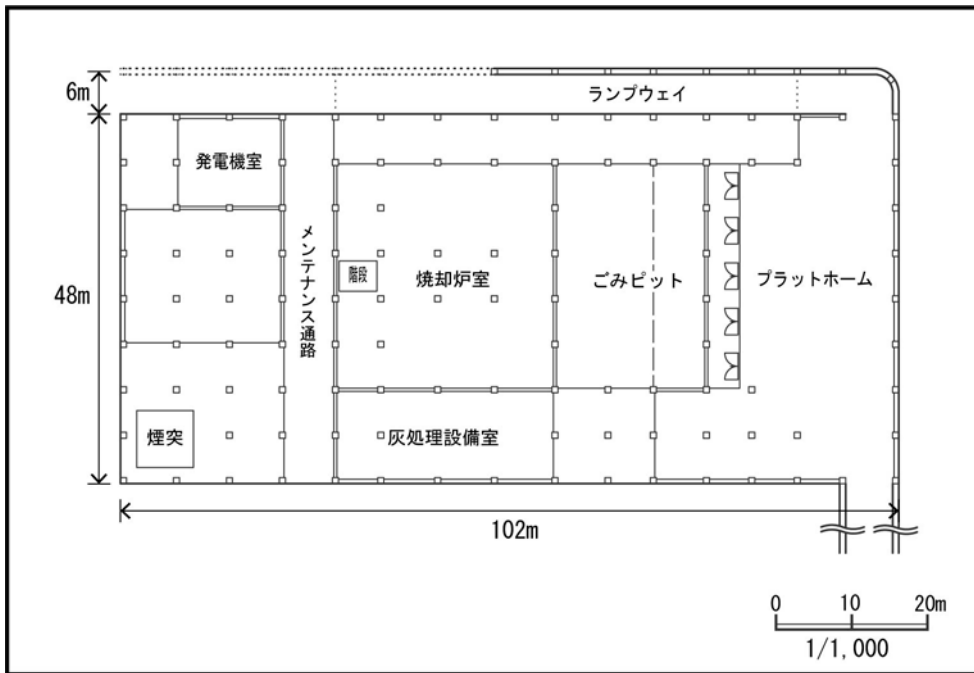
(3) 新施設の平面図 (新焼却処理施設 2 階)
